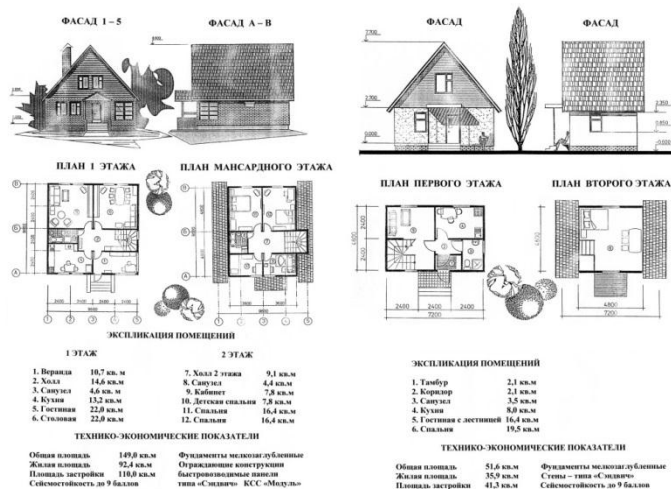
Отдельно стоящие быстровозводимые жилые дома общей площадью 149,0 кв.м. и 51,6 кв.м. Фасады, планы.
